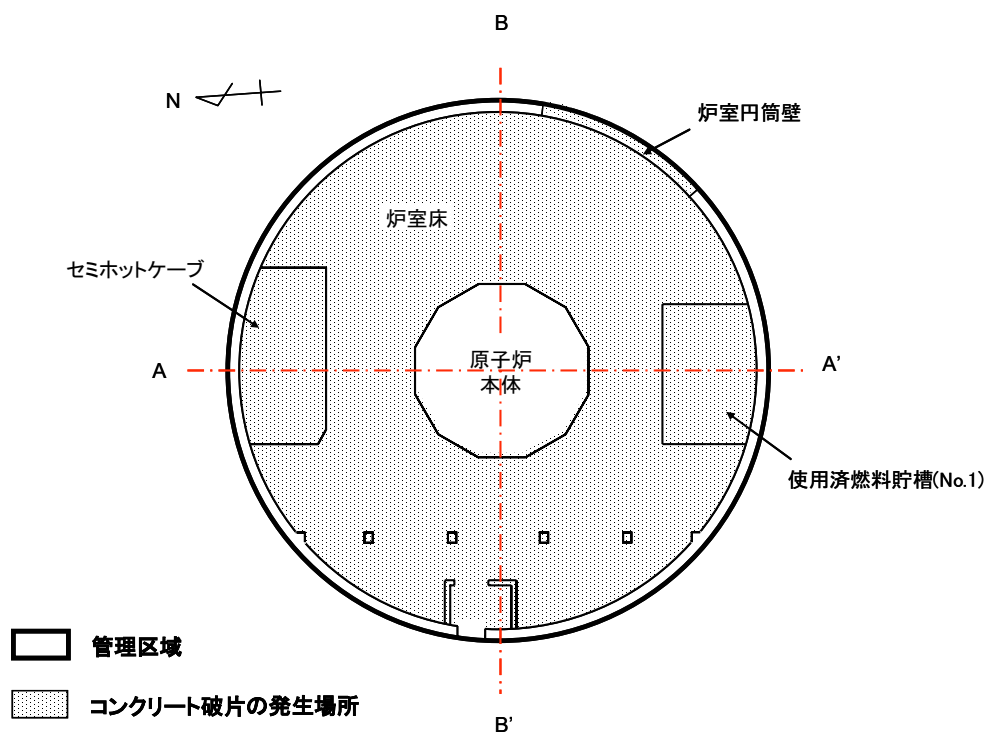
コンクリート破片の発生場所(炉室1階、C-C'平面図)
